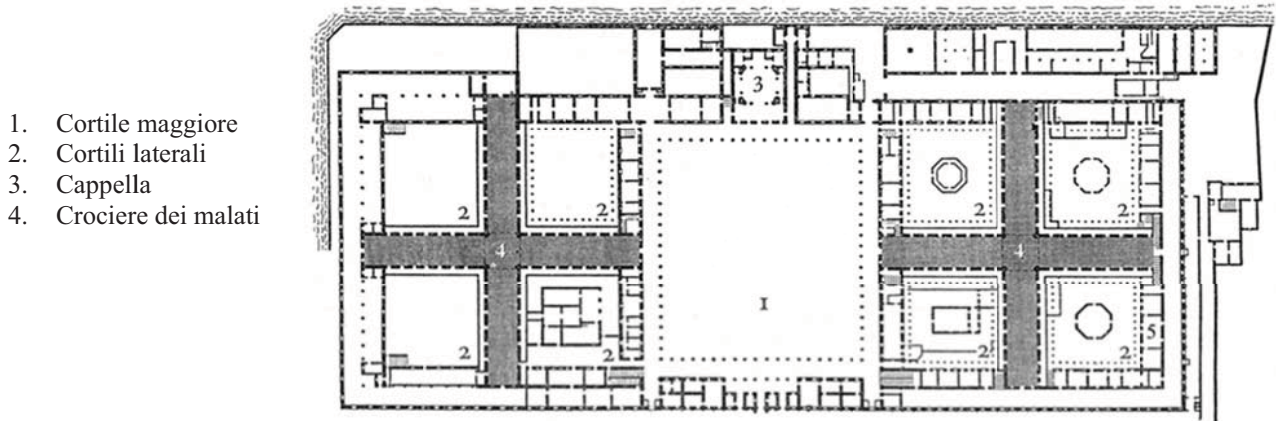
Pianta dell'Ospedale Cà Grande, Milano, 1456
